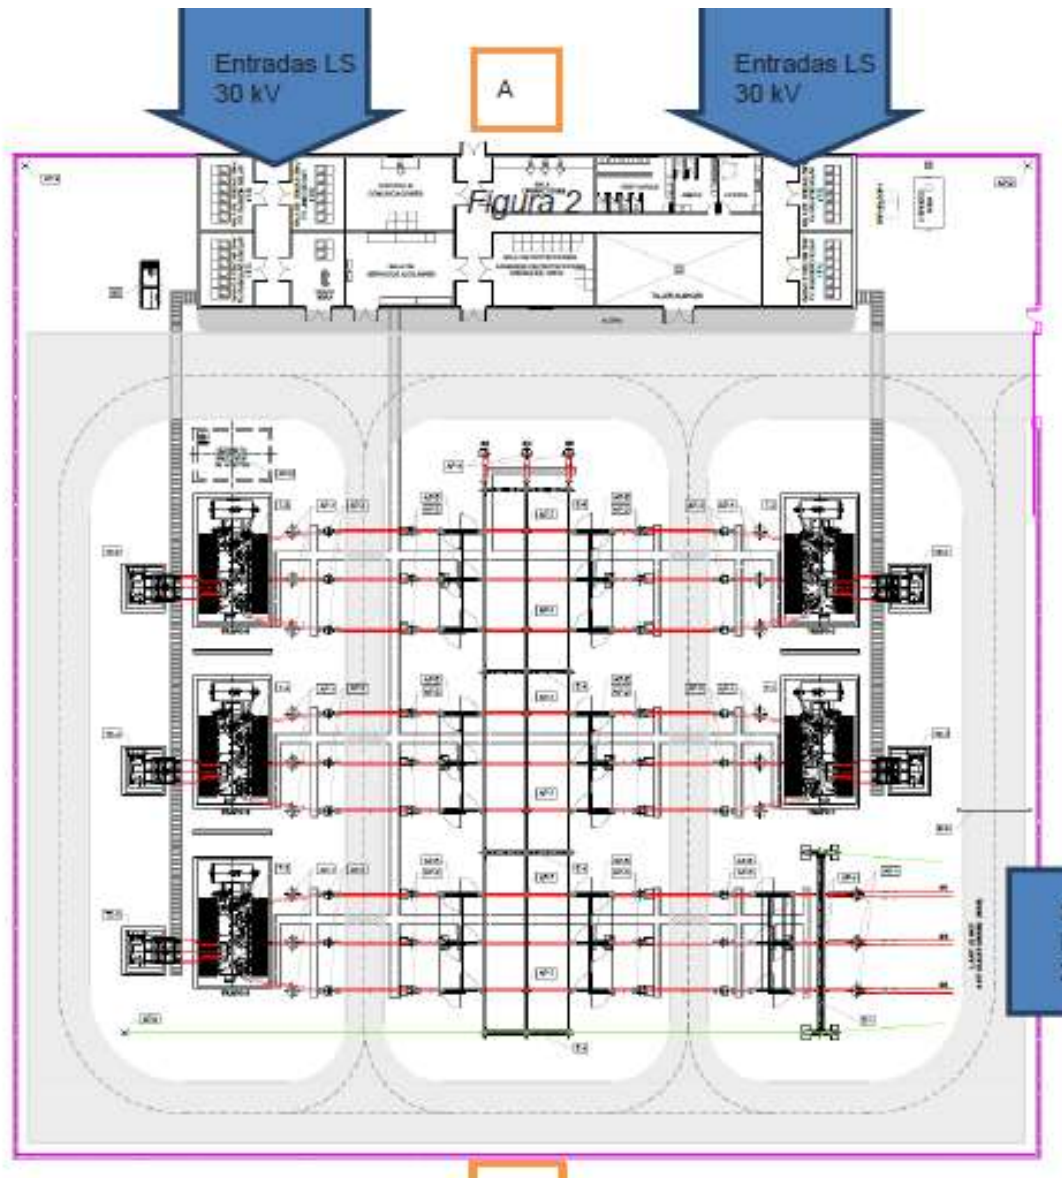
Planta i secció de la nova SET Seròs.
